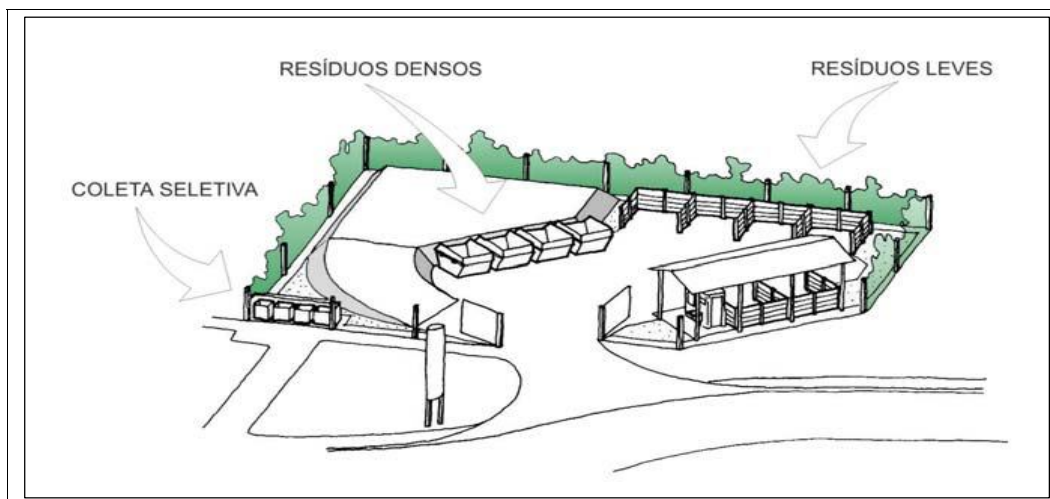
Esquema de Layout sugerido para ponto de entrega.
